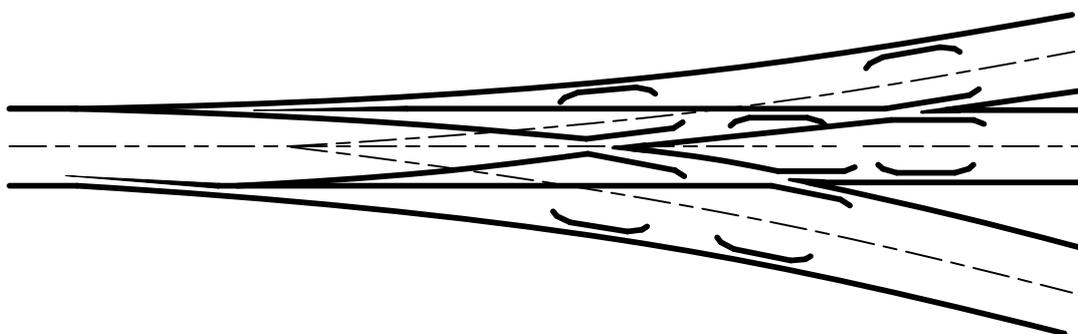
Схема перевода стрелочного двойного несимметричного
